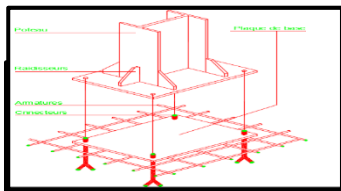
Fixation poteau en radier (Source : Cours de 2eme année atelier de construction architecture, atelier de construction)
